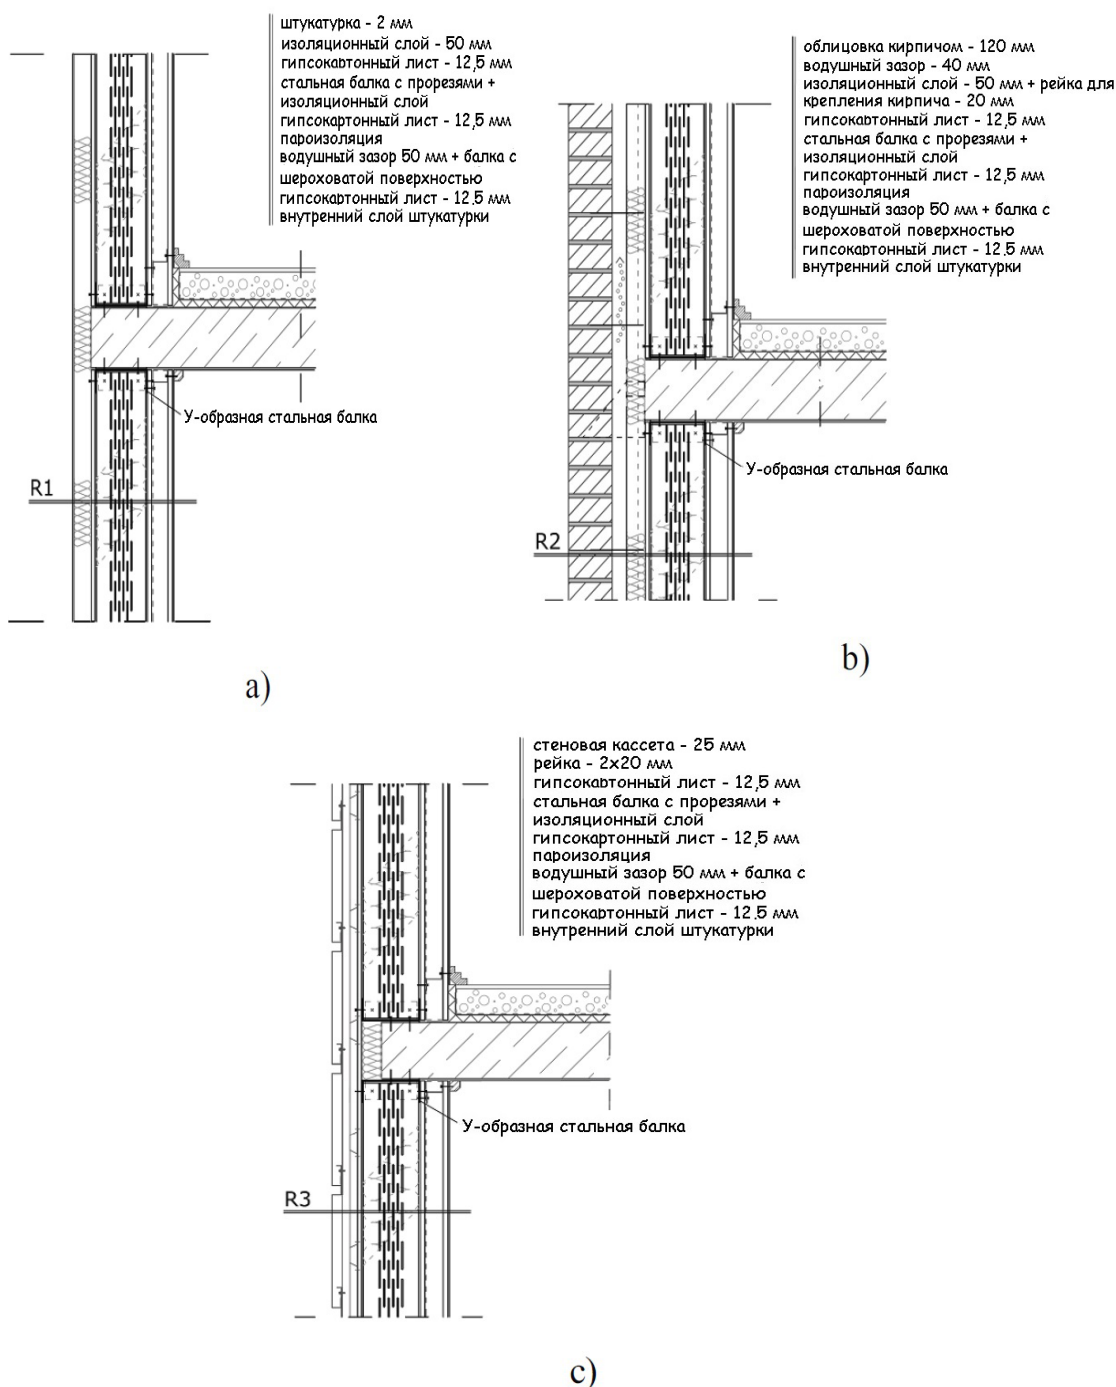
а) Фасад с облицовкой штукатуркой, б) Фасад с облицовкой кирпичом, в) Фасад с облицовкой стеновой кассетой
